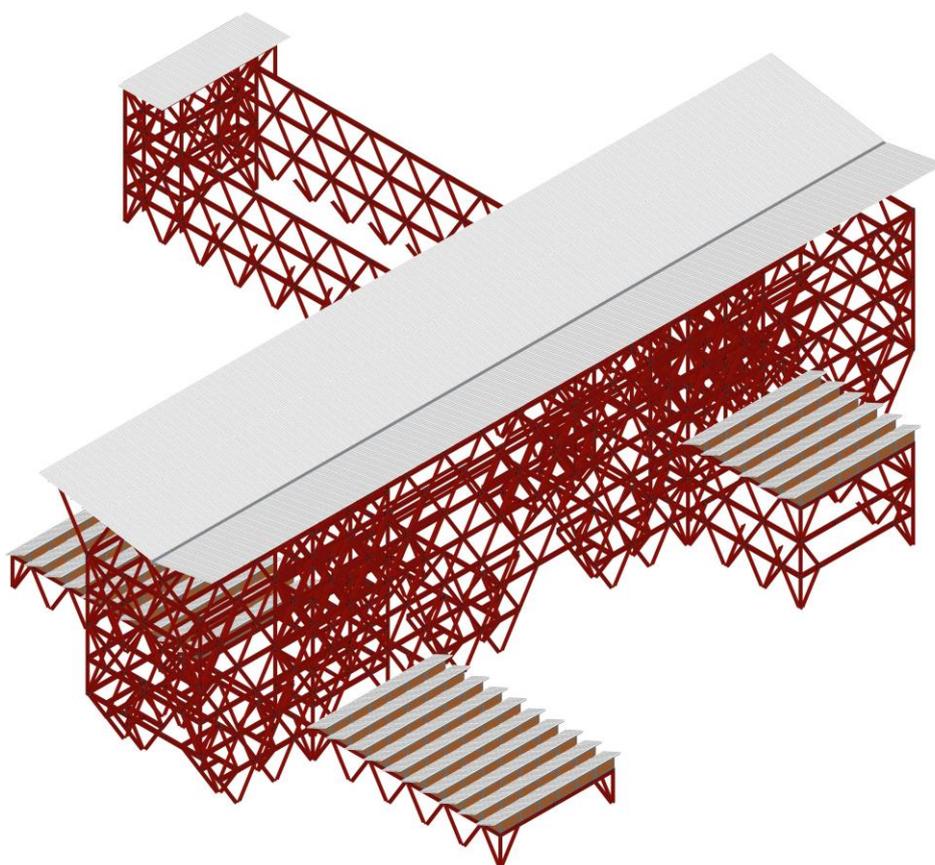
Esquema Estrutural em perspectiva (sem escala)
